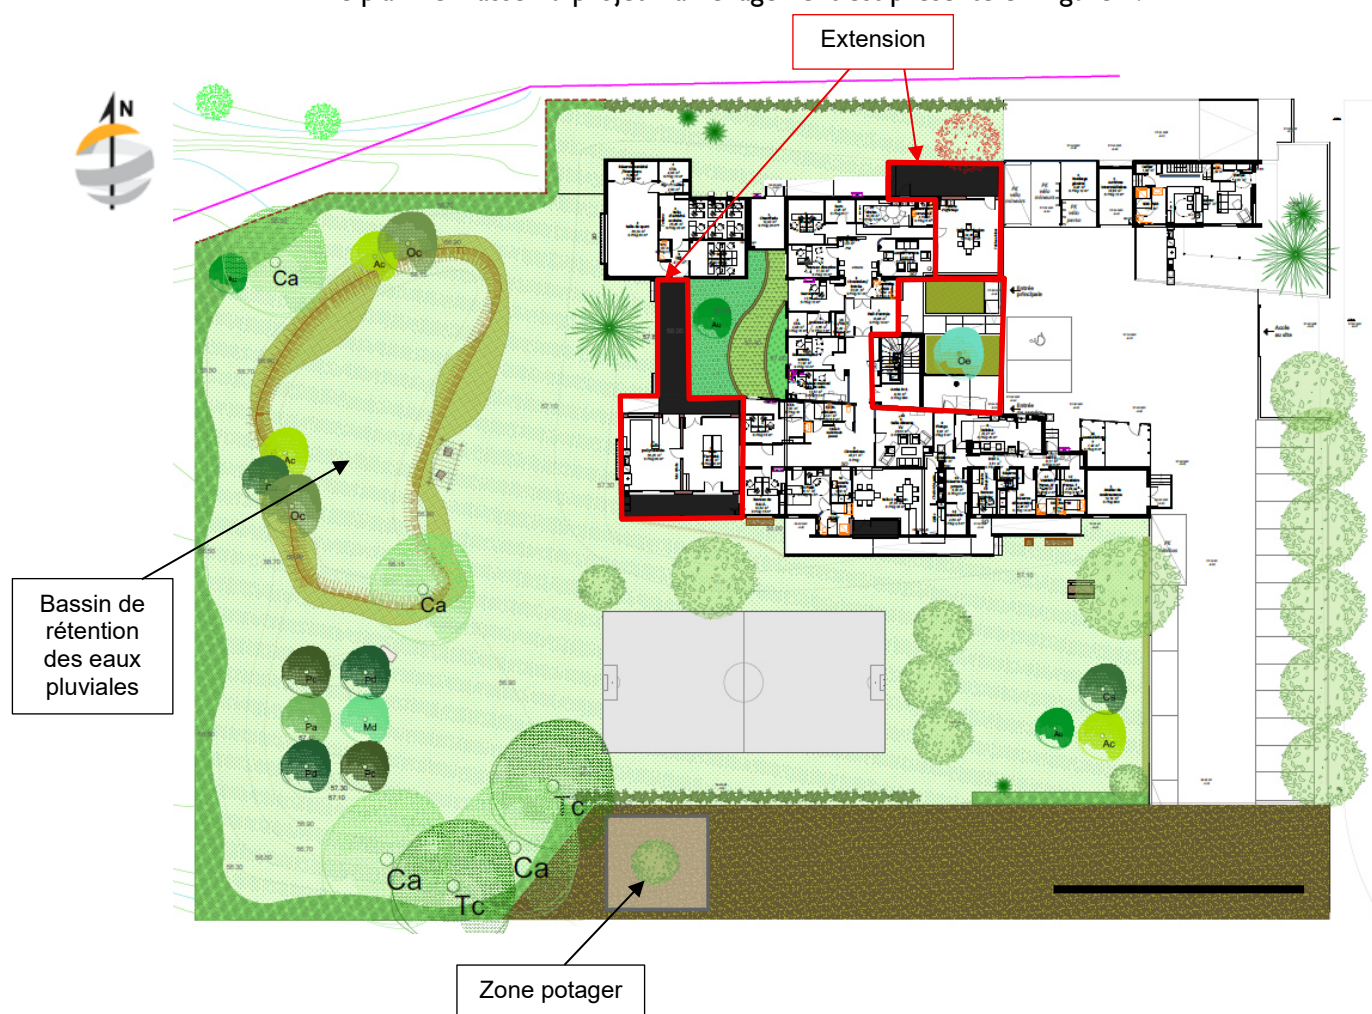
Plan de masse du projet d'aménagement (source : Ministère de la Justice, plan daté du 03/12/2025)
